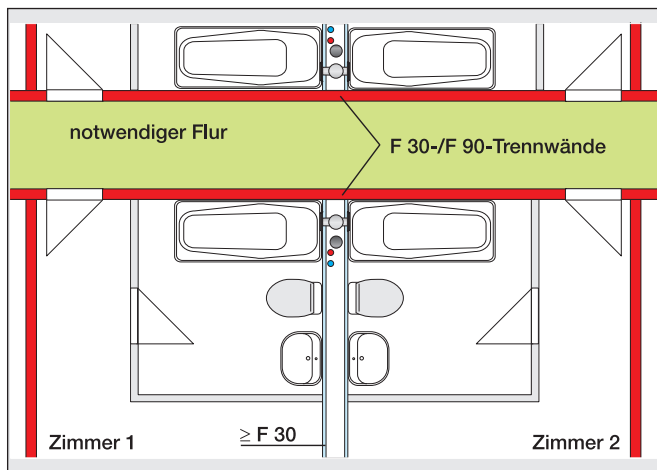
Sanitärraumanordnung eines Hotels mit Nutzungseinheiten pro Hotelzimmer mit einer F 30 Zimmertrennwand. Alle Leitungsanlagen müssen bei den "F 30-Ländern" in der Trennwand geschottet werden.
